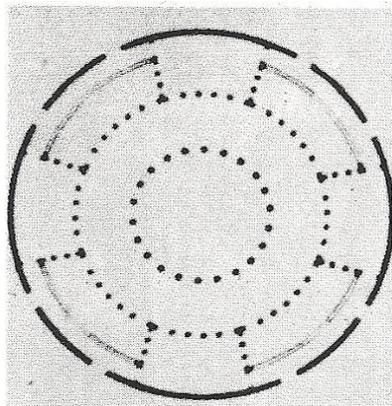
Planta original da Igreja S. Stefano Rotondo.
